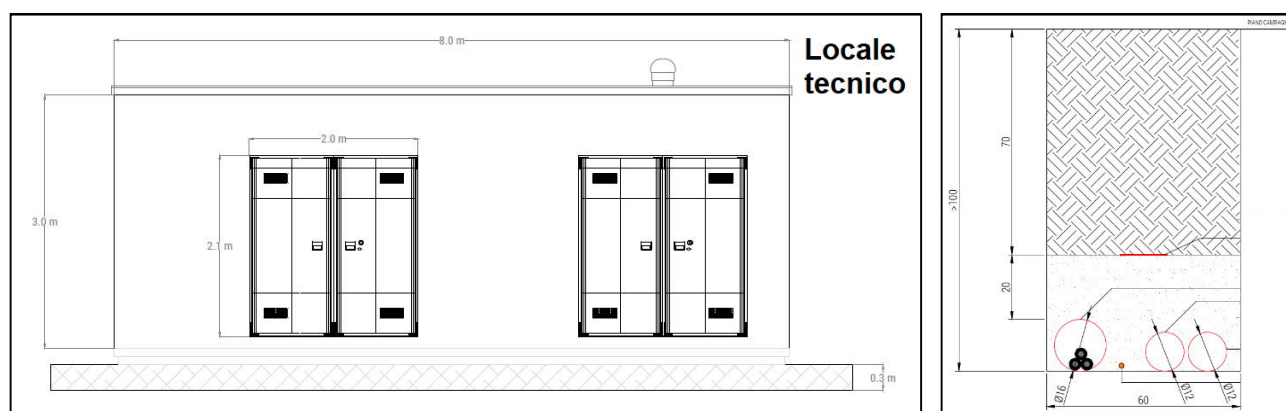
,8_Prospetto del locale tecnico e sezione dei sottoservizi con rispettive profondità di scavo.
